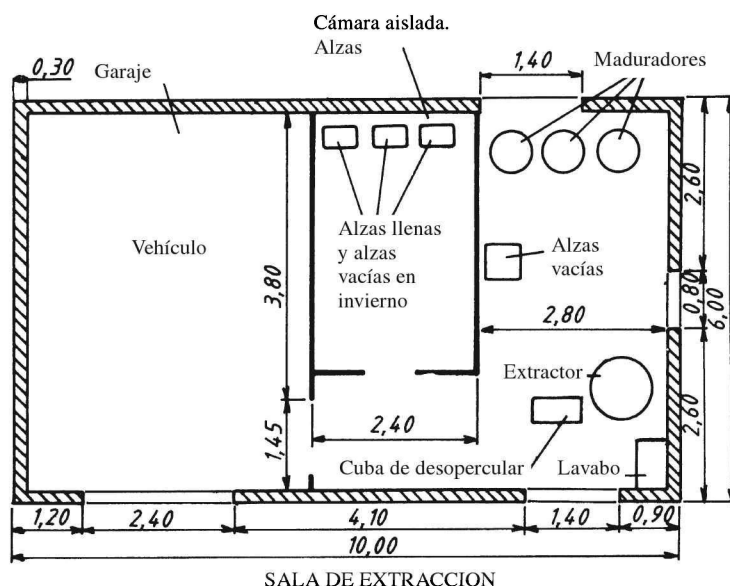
Plano de construcción apícola de J-P A. en Hyères (escala 1:100).
